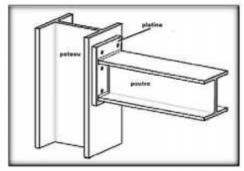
assemblage poteau-poutre source :www.infosteel.be
